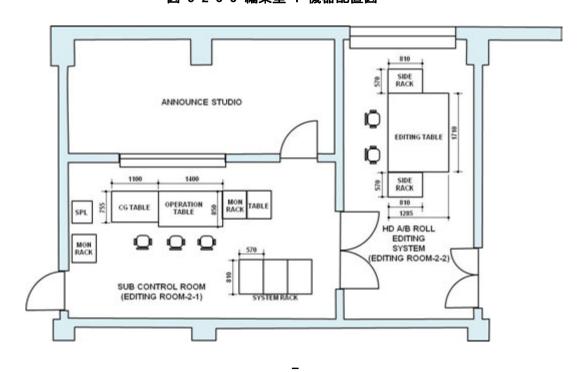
編集室-2-1/編集室-2-2 機器配置図
